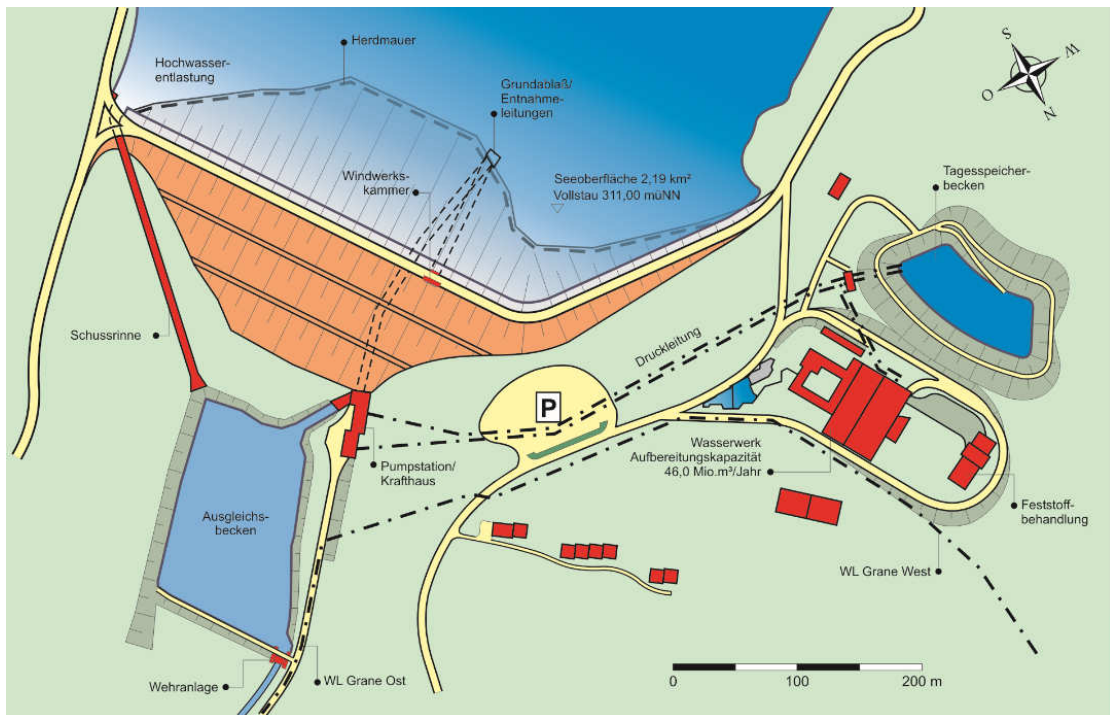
Granetalsperre Lageplan mit Rohrleitungsführung
